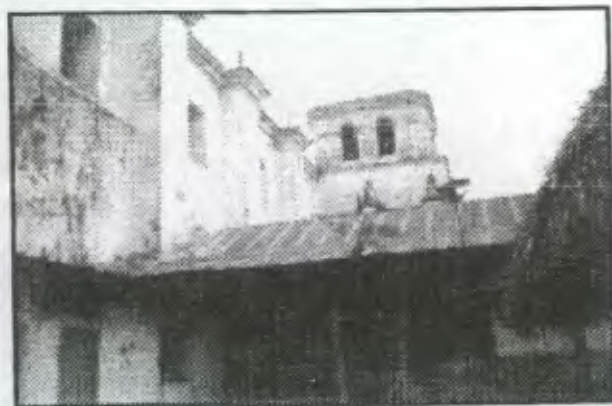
La unión con la casa parroquial provoca daños severos al muro como la humedad, mientras altera la estructura original.
